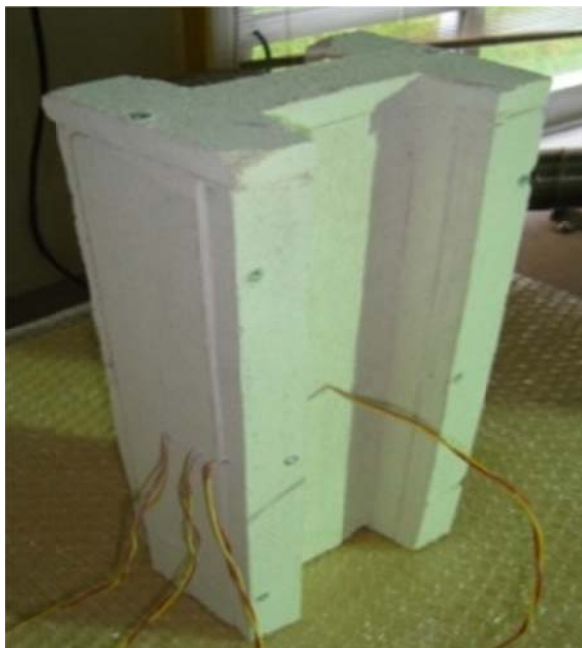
Elemento estrutural com protecção de silicato de cálcio.
